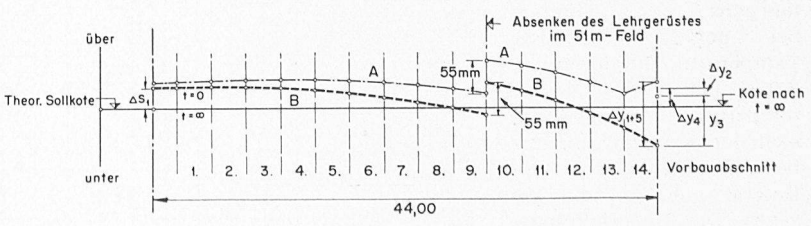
Berechnungsschema der Höhenkoten für den Freivorbau
